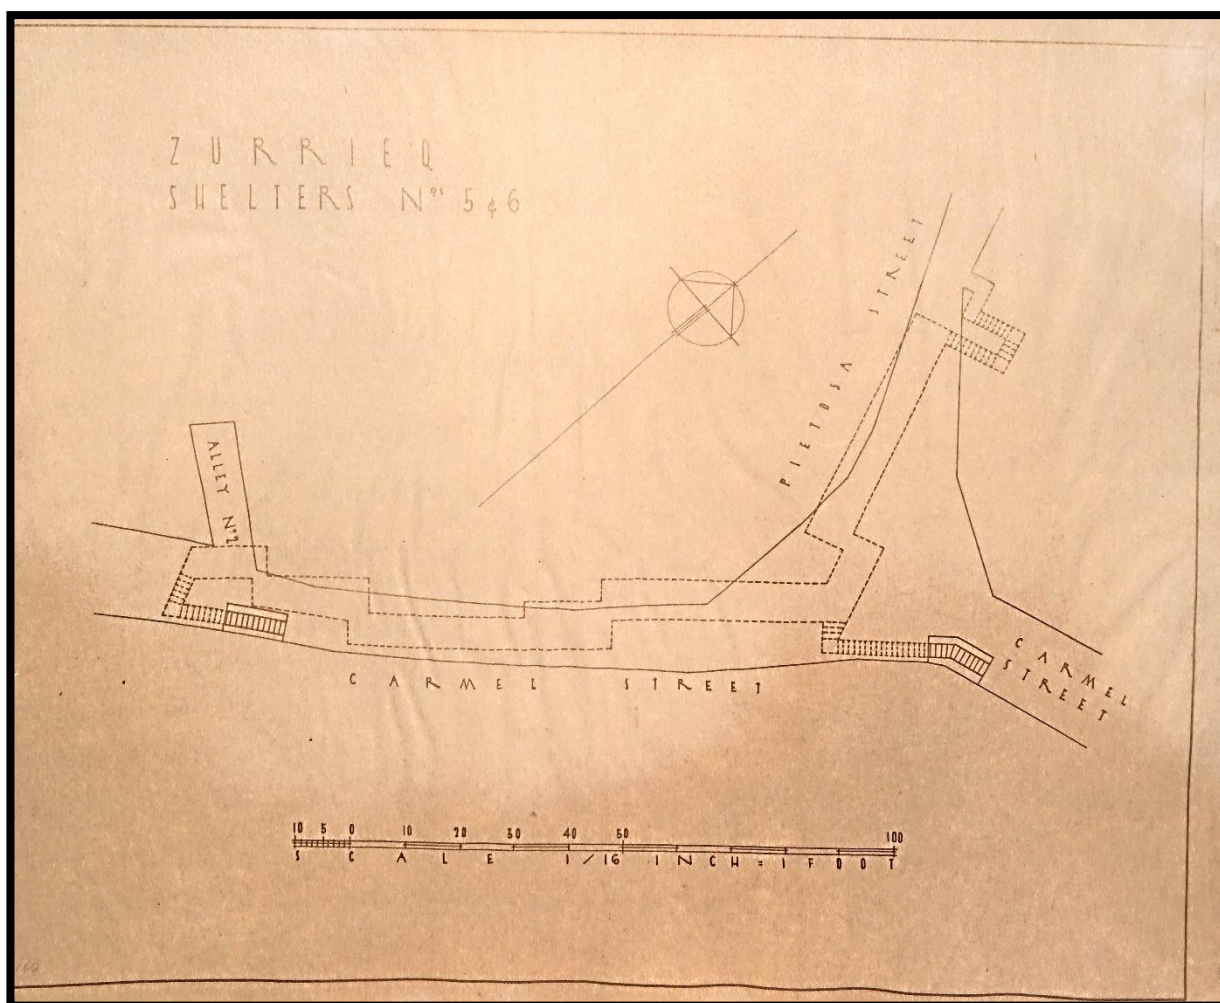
Planta do abrigo nº5 e 6 "Carmel Street – Pietdsa Street" – Alley nº2"
